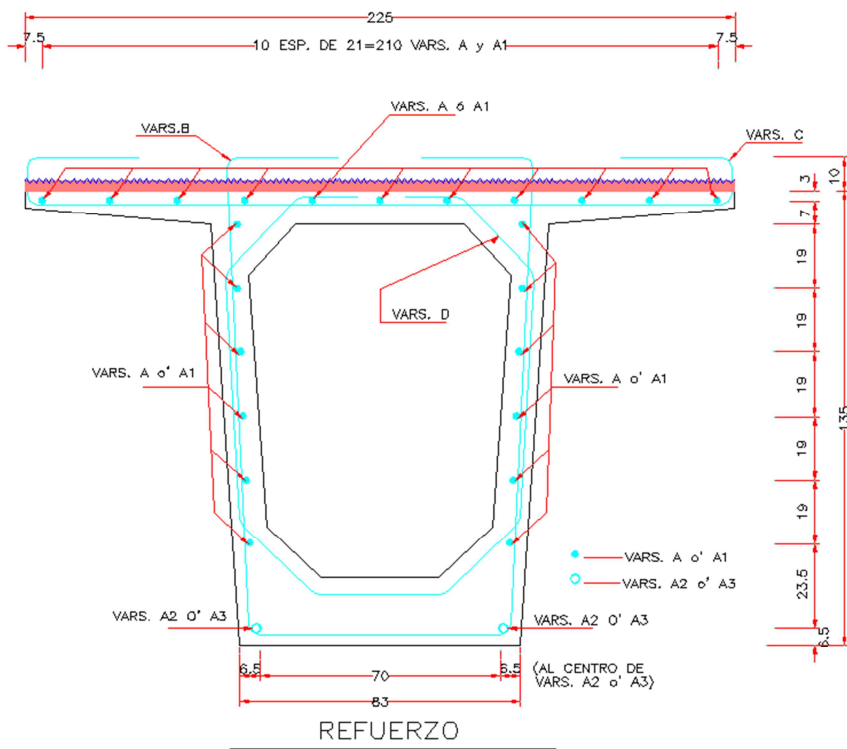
Sección transversal, trabe tipo cajón. Refuerzo
